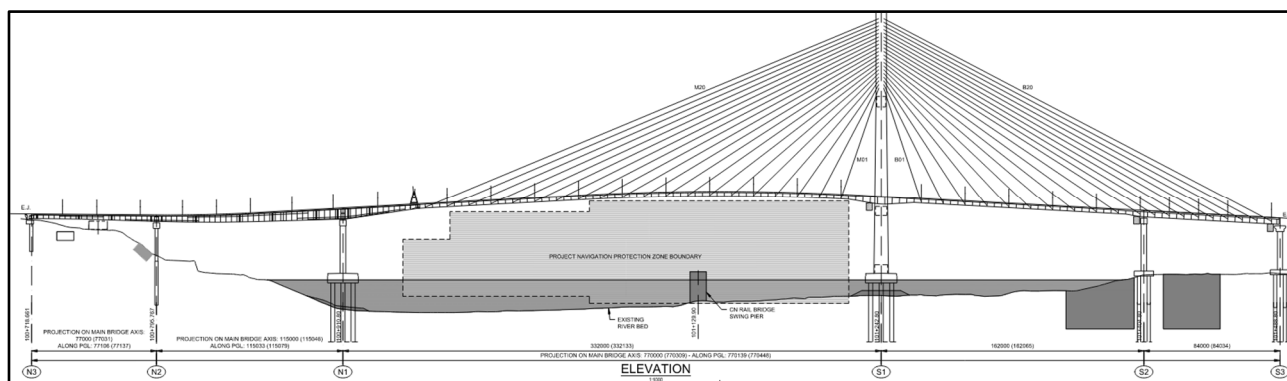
Alzado longitudinal del Puente. Pilas S1-S2-S3 (Surrey)-N1-N2-N3 (City of New Westminster)
